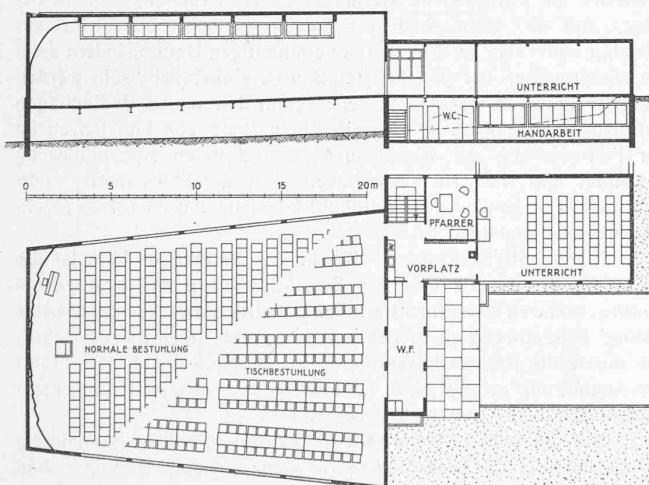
Grundriss und Längsschnitt. — Masstab 1 : 400.
